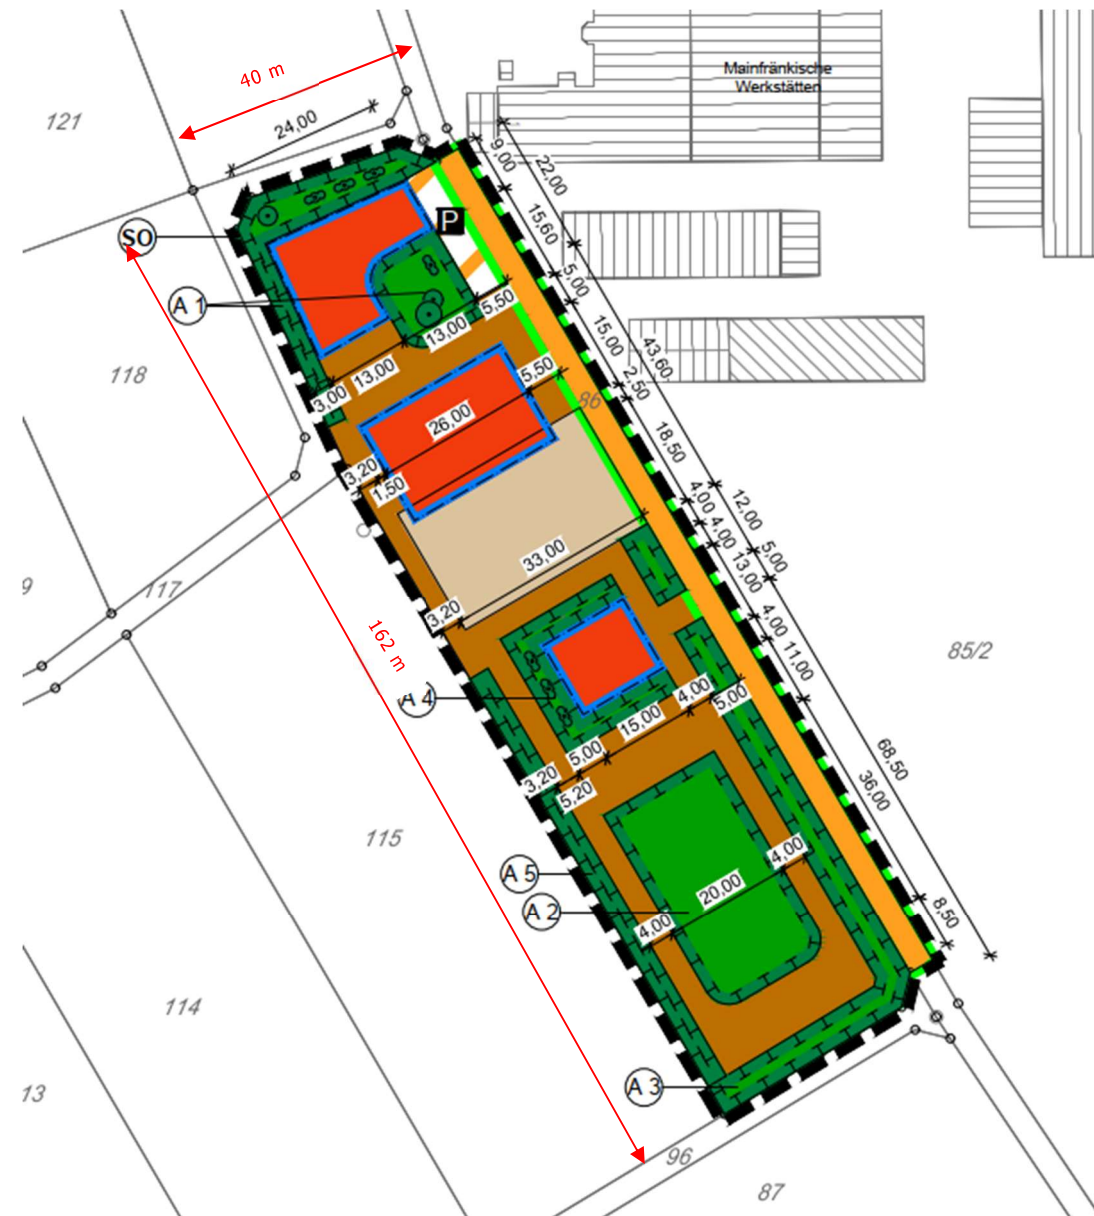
Übersichtslageplan Bebauungsplan „Reitanlage Schwarzenau Süd“
